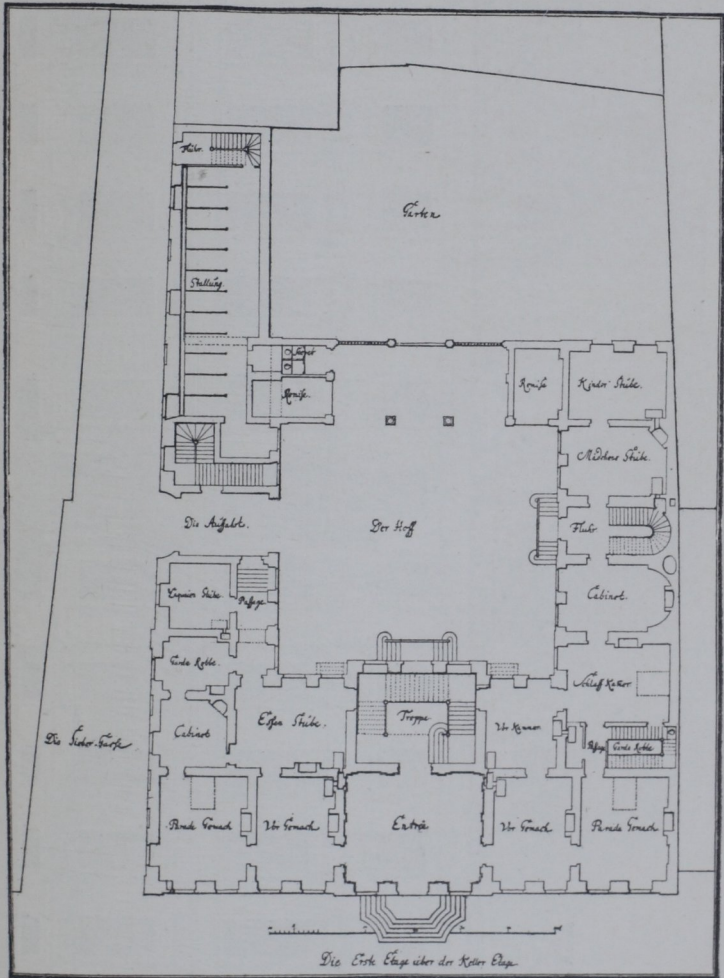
Kreuz'sches Palais zu Berlin. Nach einem alten Plan. 168)
